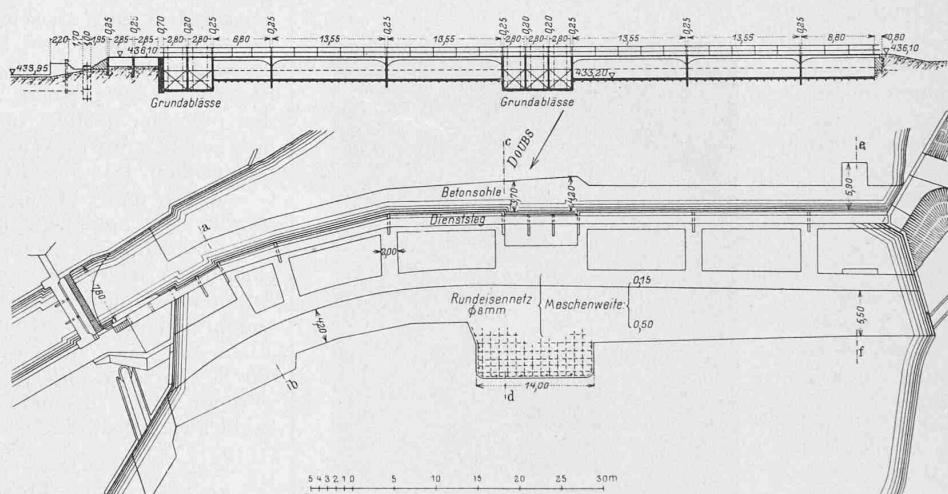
Lageplan und Längsschnitt des Wehrs. — Maßstab 1:800.
